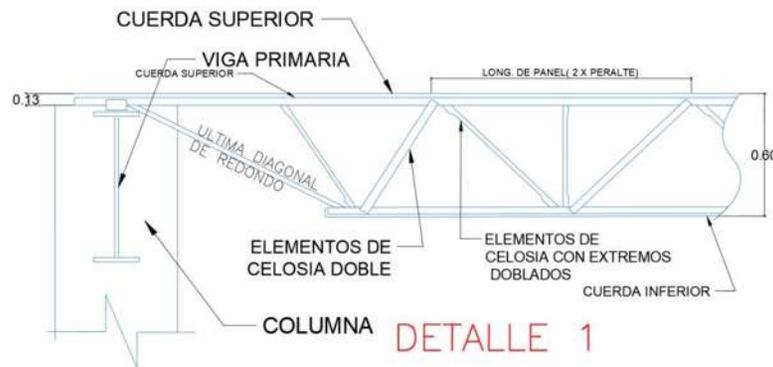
ESTRUCTURA JOIST FUENTE: [http://www.arquitecturaenacero.org/uso-y-aplicaciones-del-acero/soluciones-constructivas/steel-i-joist\(20-abril/2018\)](http://www.arquitecturaenacero.org/uso-y-aplicaciones-del-acero/soluciones-constructivas/steel-i-joist(20-abril/2018))
